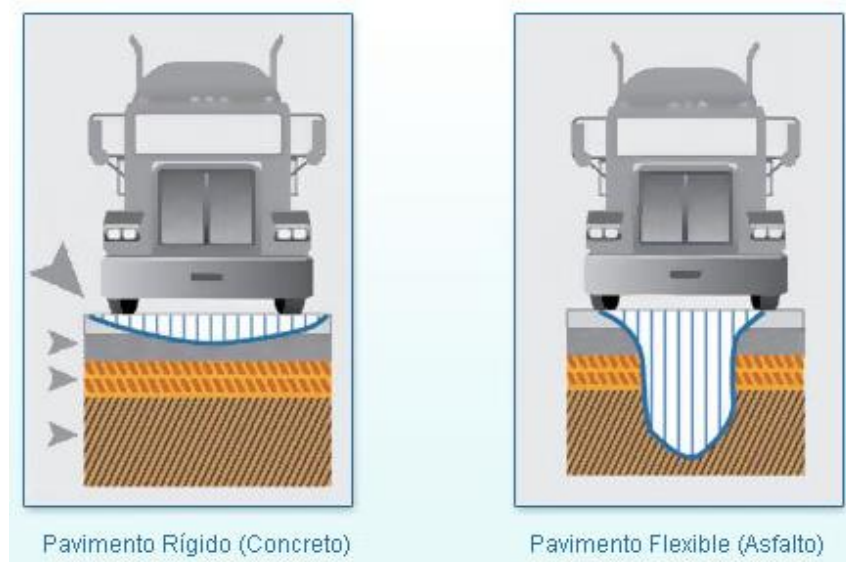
Diferencia de Transferencia de cargas entre un pavimento rígido y flexible, por Duravía, 2017.
